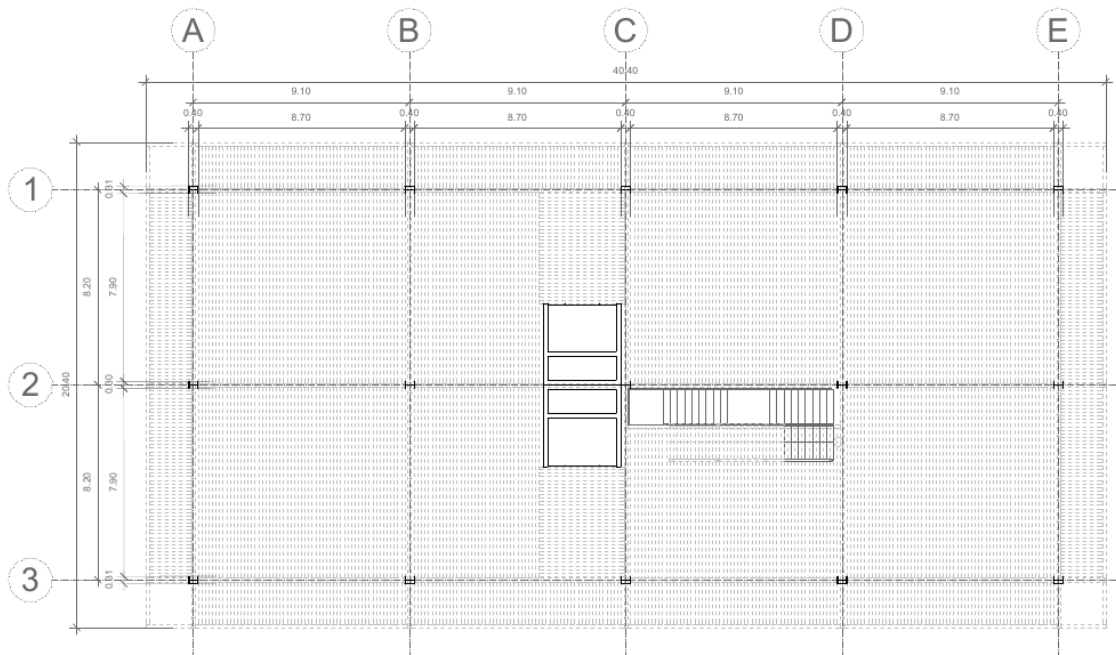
Entramado de vigas y correas en el entrapado, Fuente: Elaboración propia
